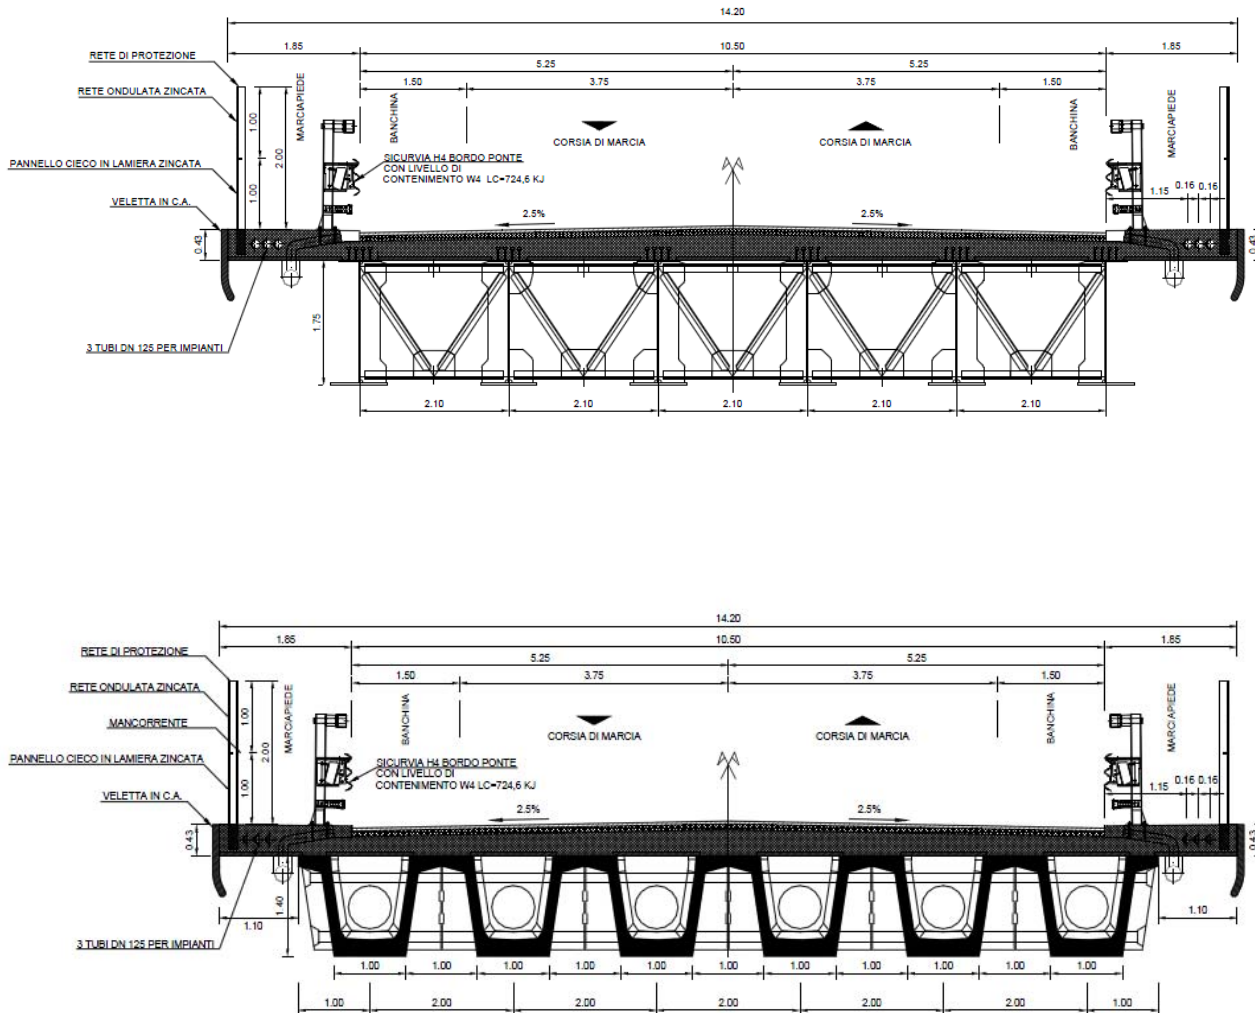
Sezioni Tipo rilevato e cavalcaferrovia
